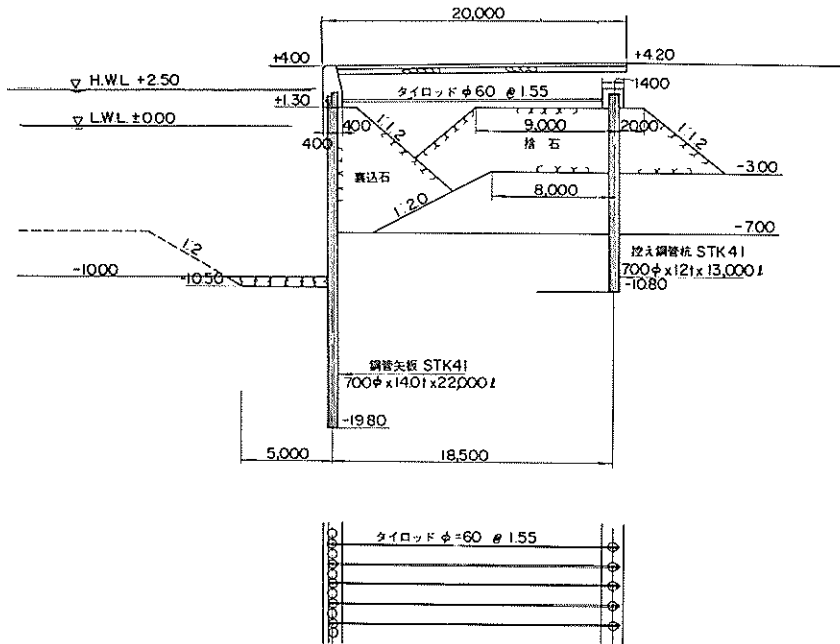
鋼矢板式 - 10.0 m岸壁標準断面図
